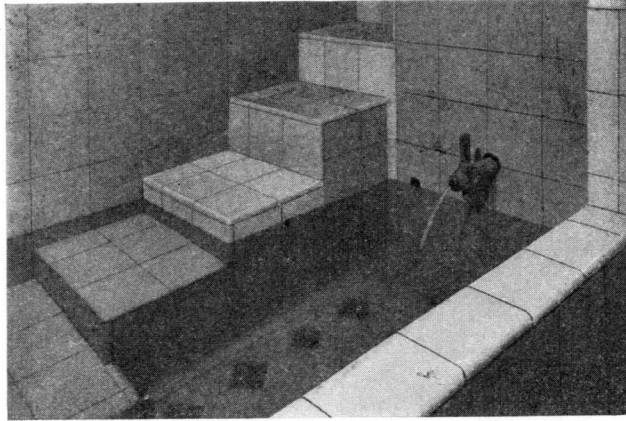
Einzelbad mit Einsteigetreppe. Thermalwasserzufluß mittels Holzhahnen
